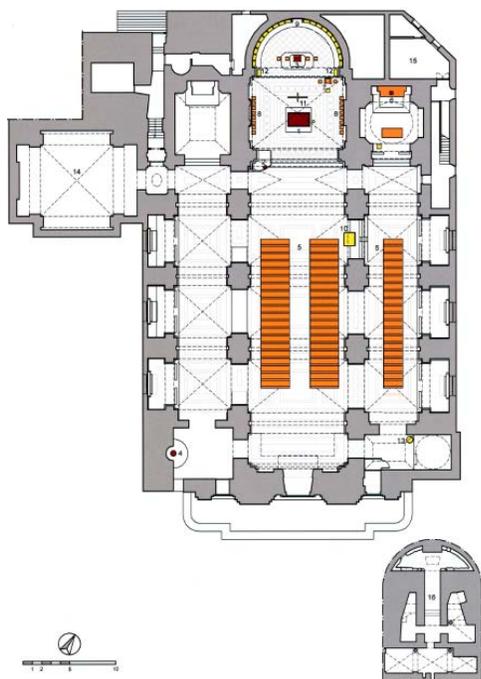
Planimetria della chiesa di S. Pancrazio ad Albano.
